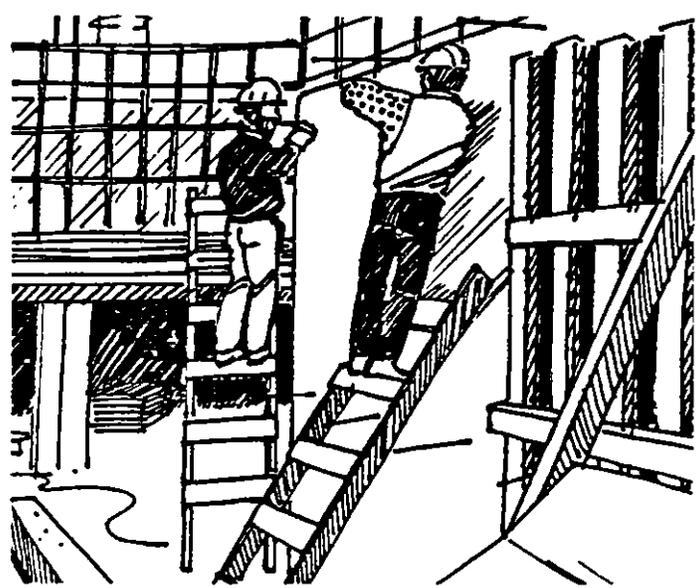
Travail sur l'échelle lors du montage du coffrage de mur.
